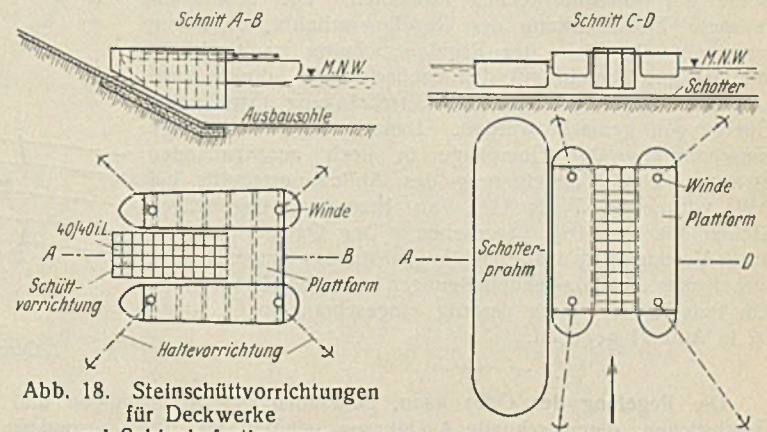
Steinschüttvorrichtungen für Deckwerke und Sohlenbefestigungen.
